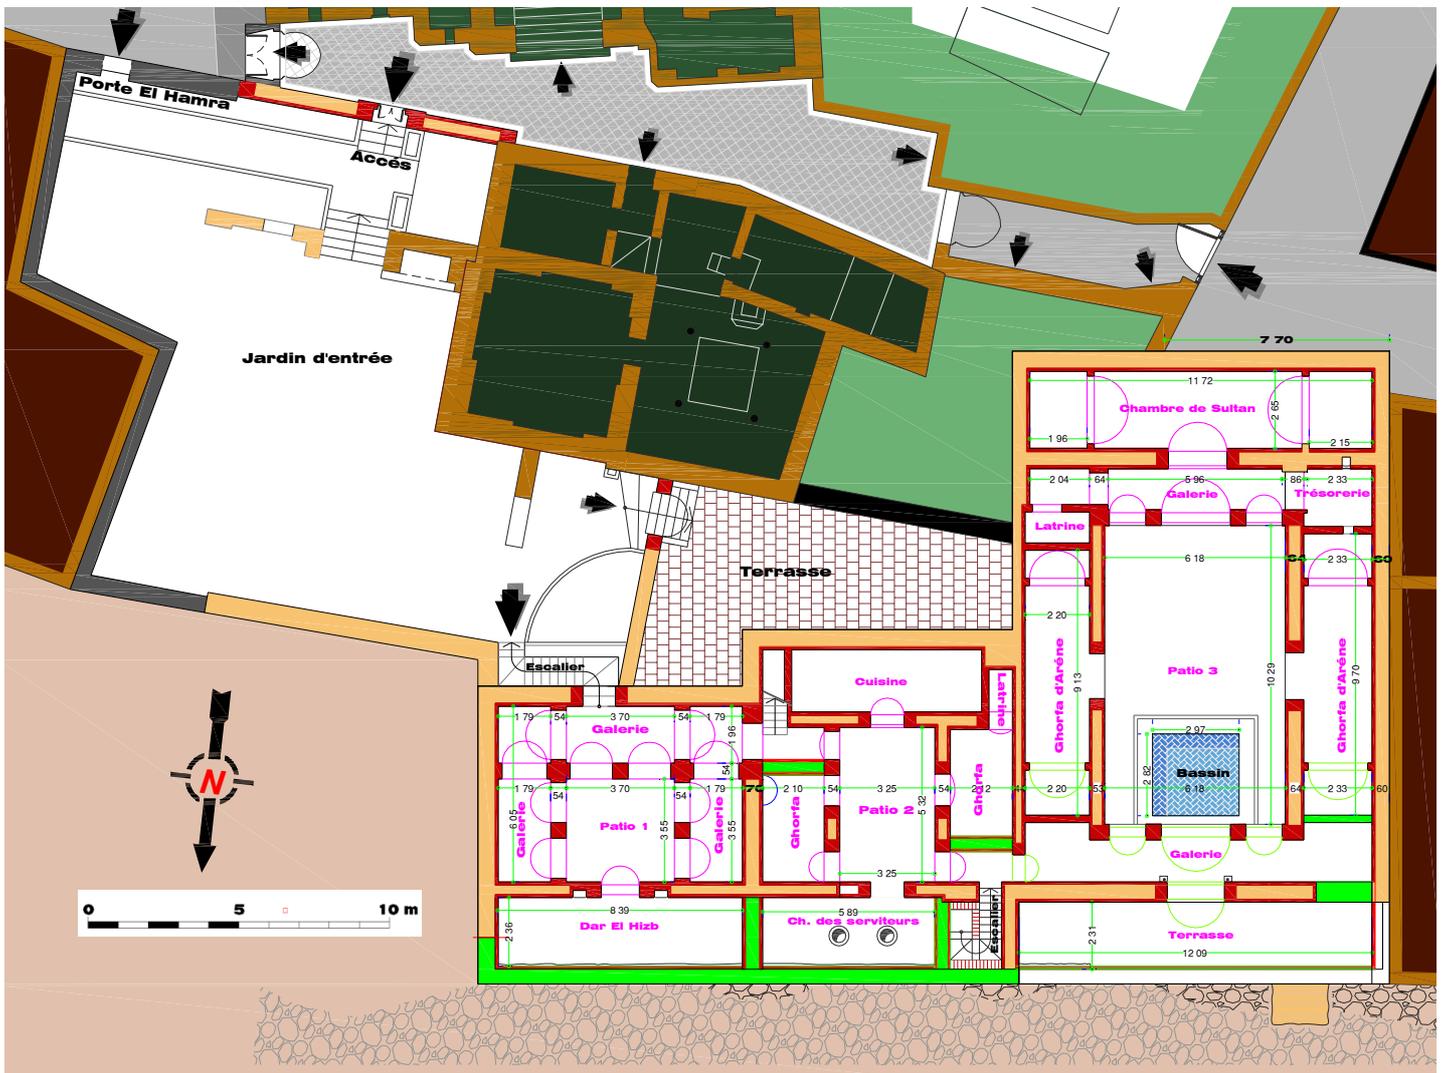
Plan de Petit Palais, Rez de Chaussée Restitué.
